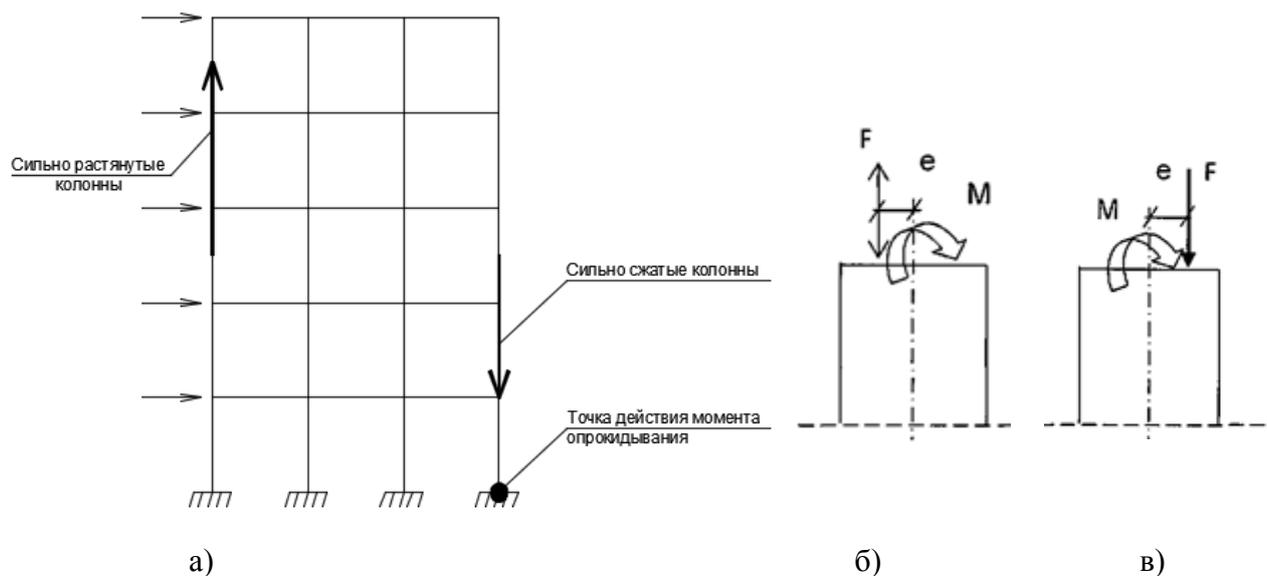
Влияние сейсмической нагрузки на работу колонн каркаса: а – схема распределения усилий; б, в – дополнительные усилия, возникающие в крайних растянутых и сжатых колоннах
